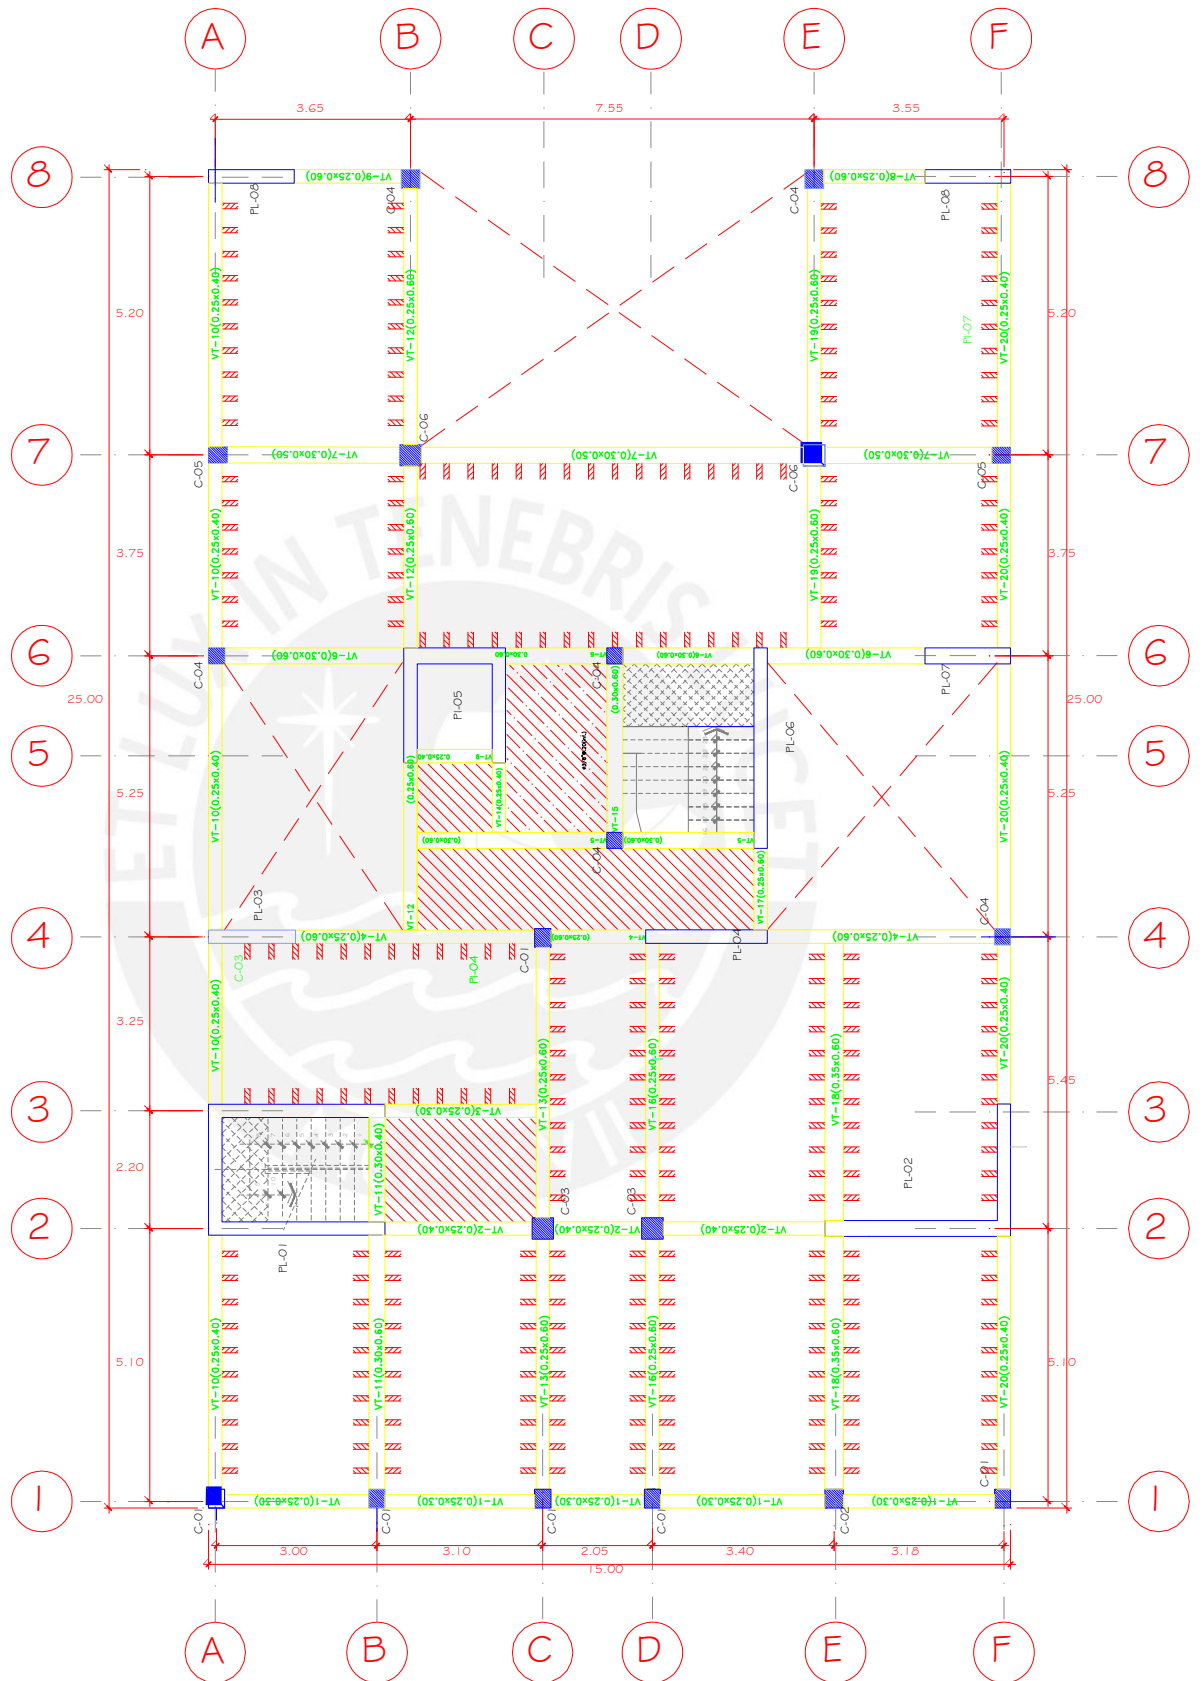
DISTRIBUCIÓN EN PLANTA DE LOS ELEMENTOS ESTRUCTURALES.
